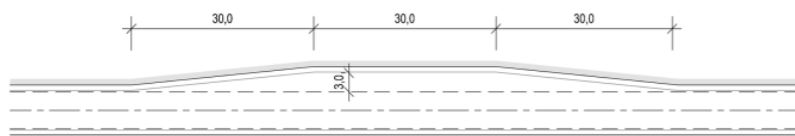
Sikkerhetsnivå i tunnel - tunnelklasse E
